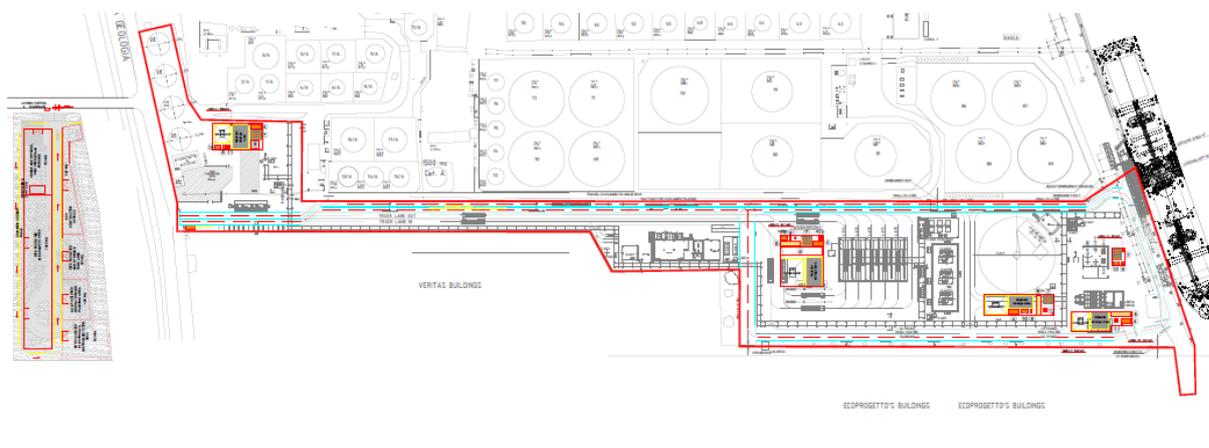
Aree di Cantiere FEED (0469-TITA-G-LY-000-001\_1\_Construction facilities layout)
